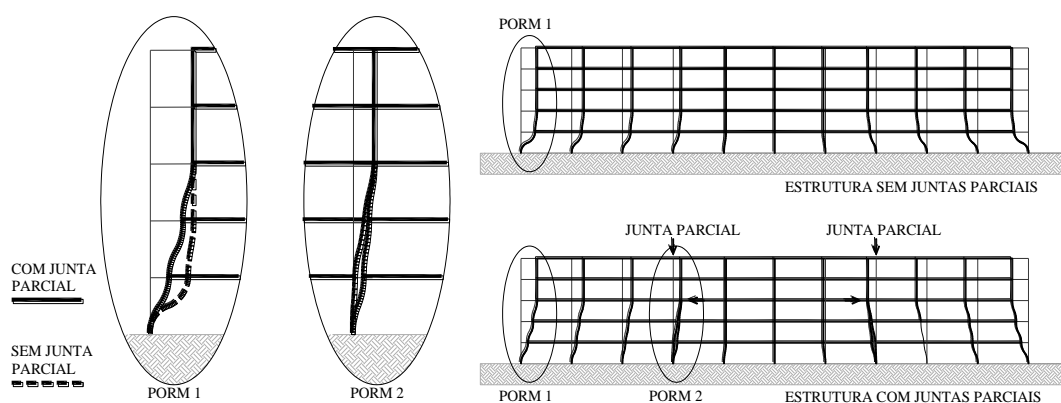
Juntas Estruturais Parciais - Esquema da configuração deformada de um pórtico com e sem juntas parciais para deformações impostas [9]
